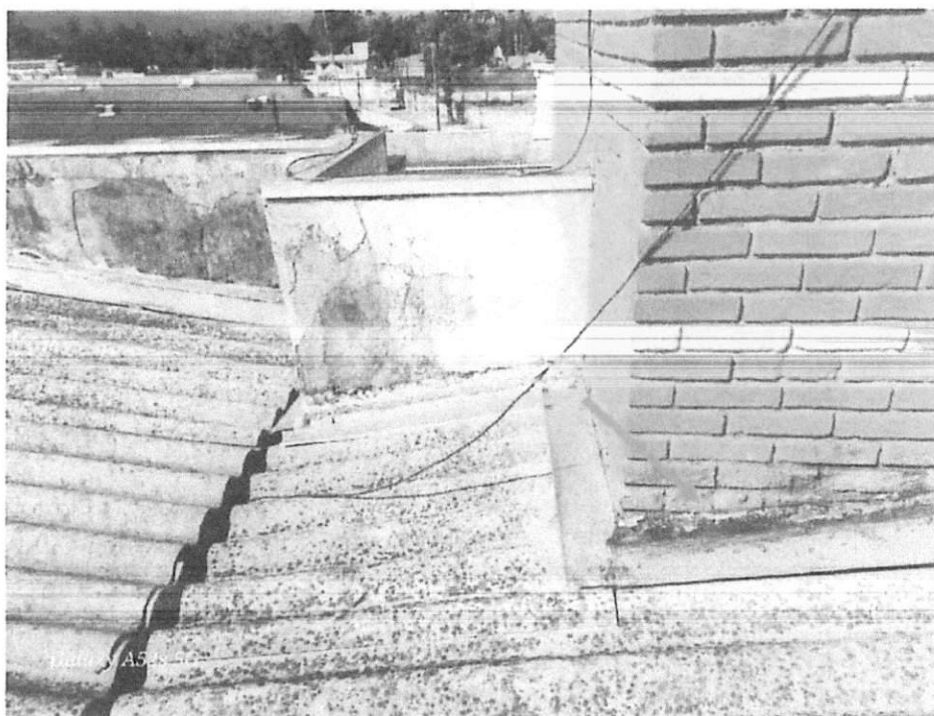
Fissuras entre o rufo e alvenaria, sendo ponto de infiltração.
